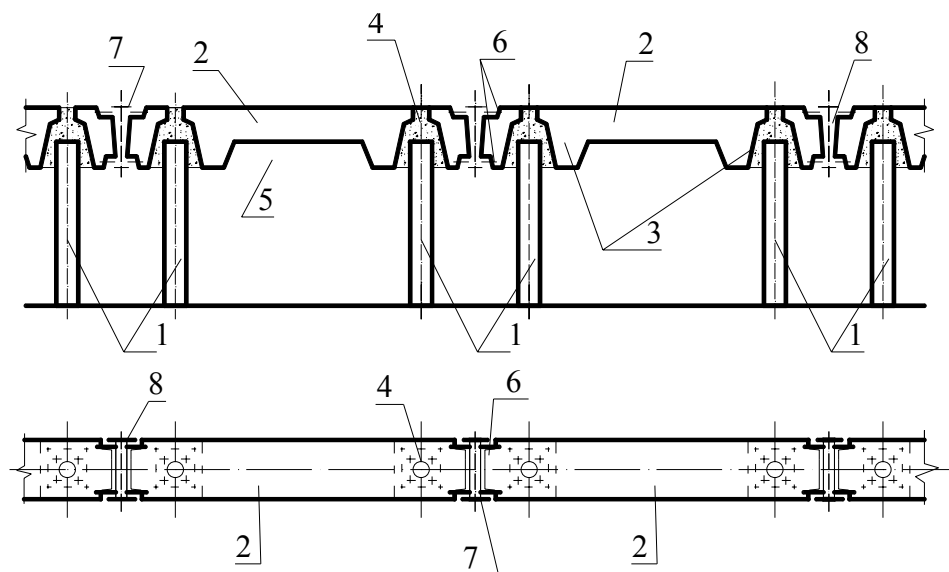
Свайный фундамент: 1 – сваи; 2 – сборные ростверки; 3 – оголовок; 4 – отверстия; 5 – полость; 6 – арматурные выпуски; 7 – стальная пластина; 8 – зазор
